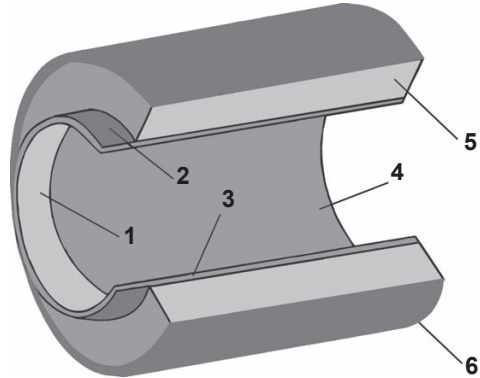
Стальная труба с гидроизоляционным слоем:
